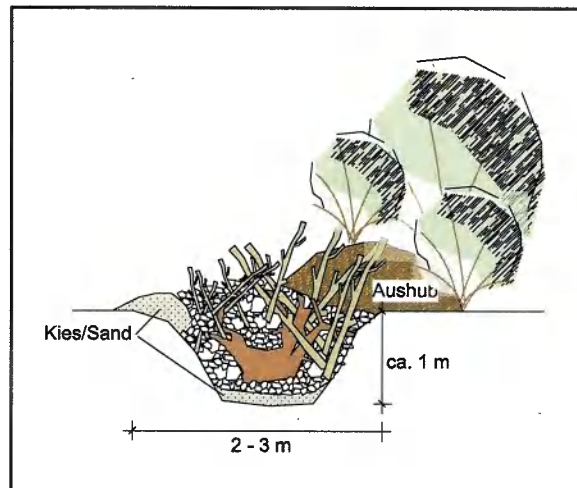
Bauschema einer überwinterungsfähigen Eidechsenburg
